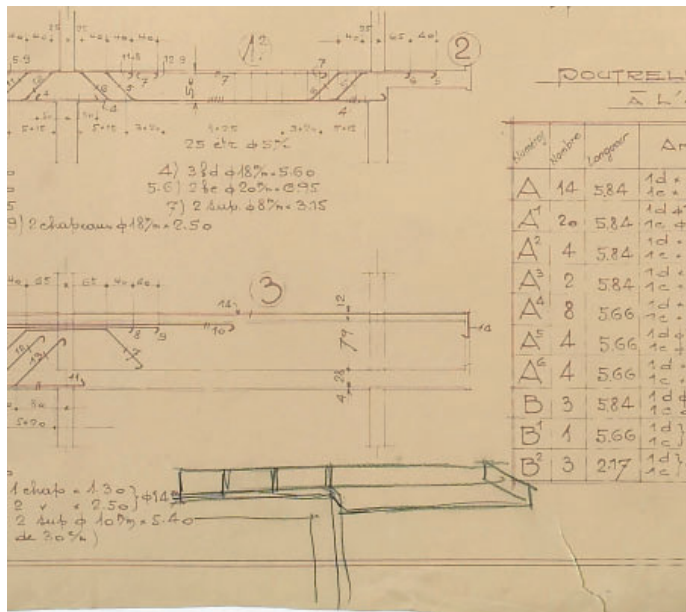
Plano del forjado de techo de planta baja de la Villa Baizeu a escalas 1:50, 1:20 y 1:10, Summer, 25-2-1929. FLC 24948 (pormenor)
